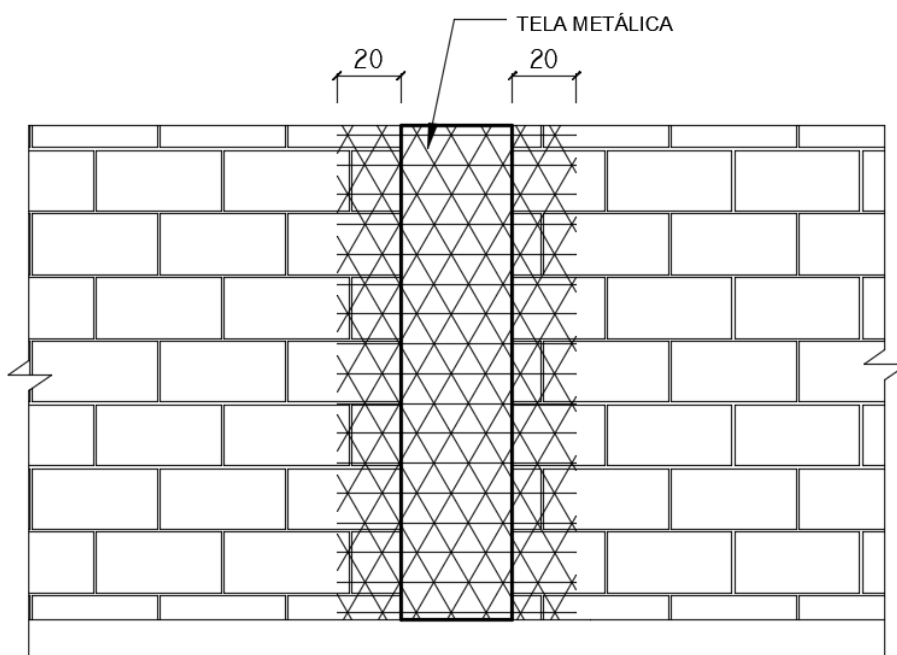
Tela metálica fixada no contato pilar/alvenaria utilizada para recuperação de elemento fissurado. Fonte: adaptado de Thomaz (1989).
